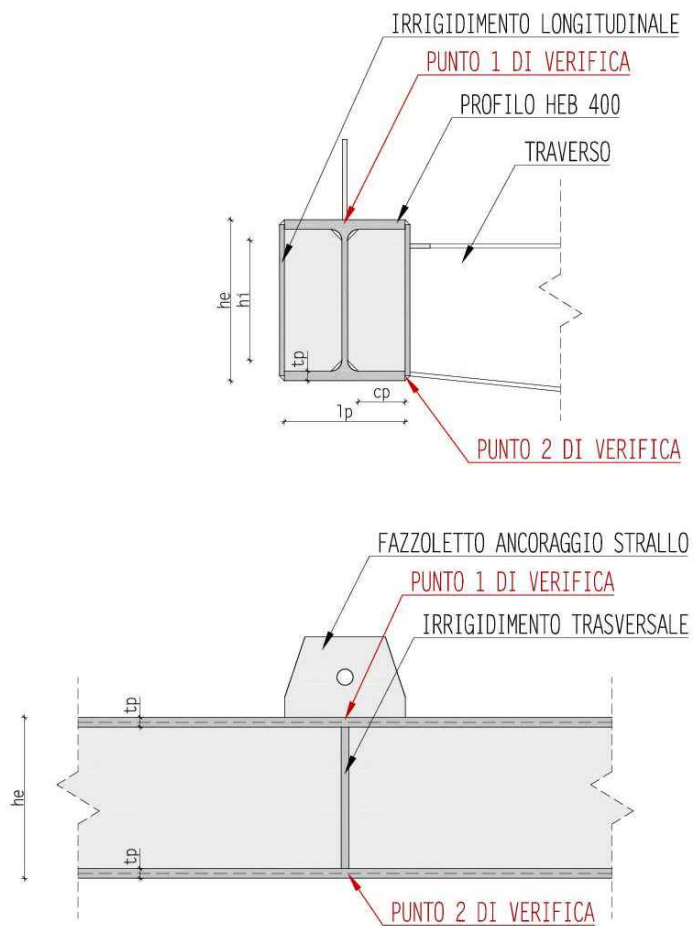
Sezione e prospettiva corrente longitudinale
